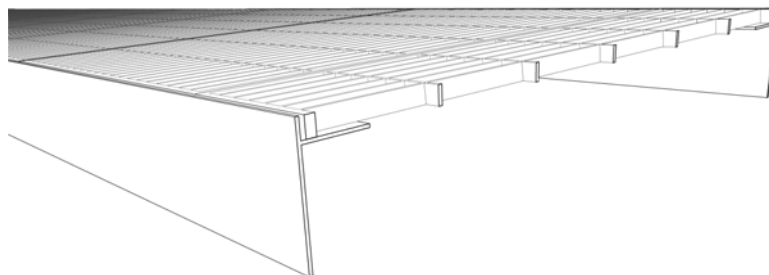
Perspectiva de corte da rampa do pavilhão proposto.
